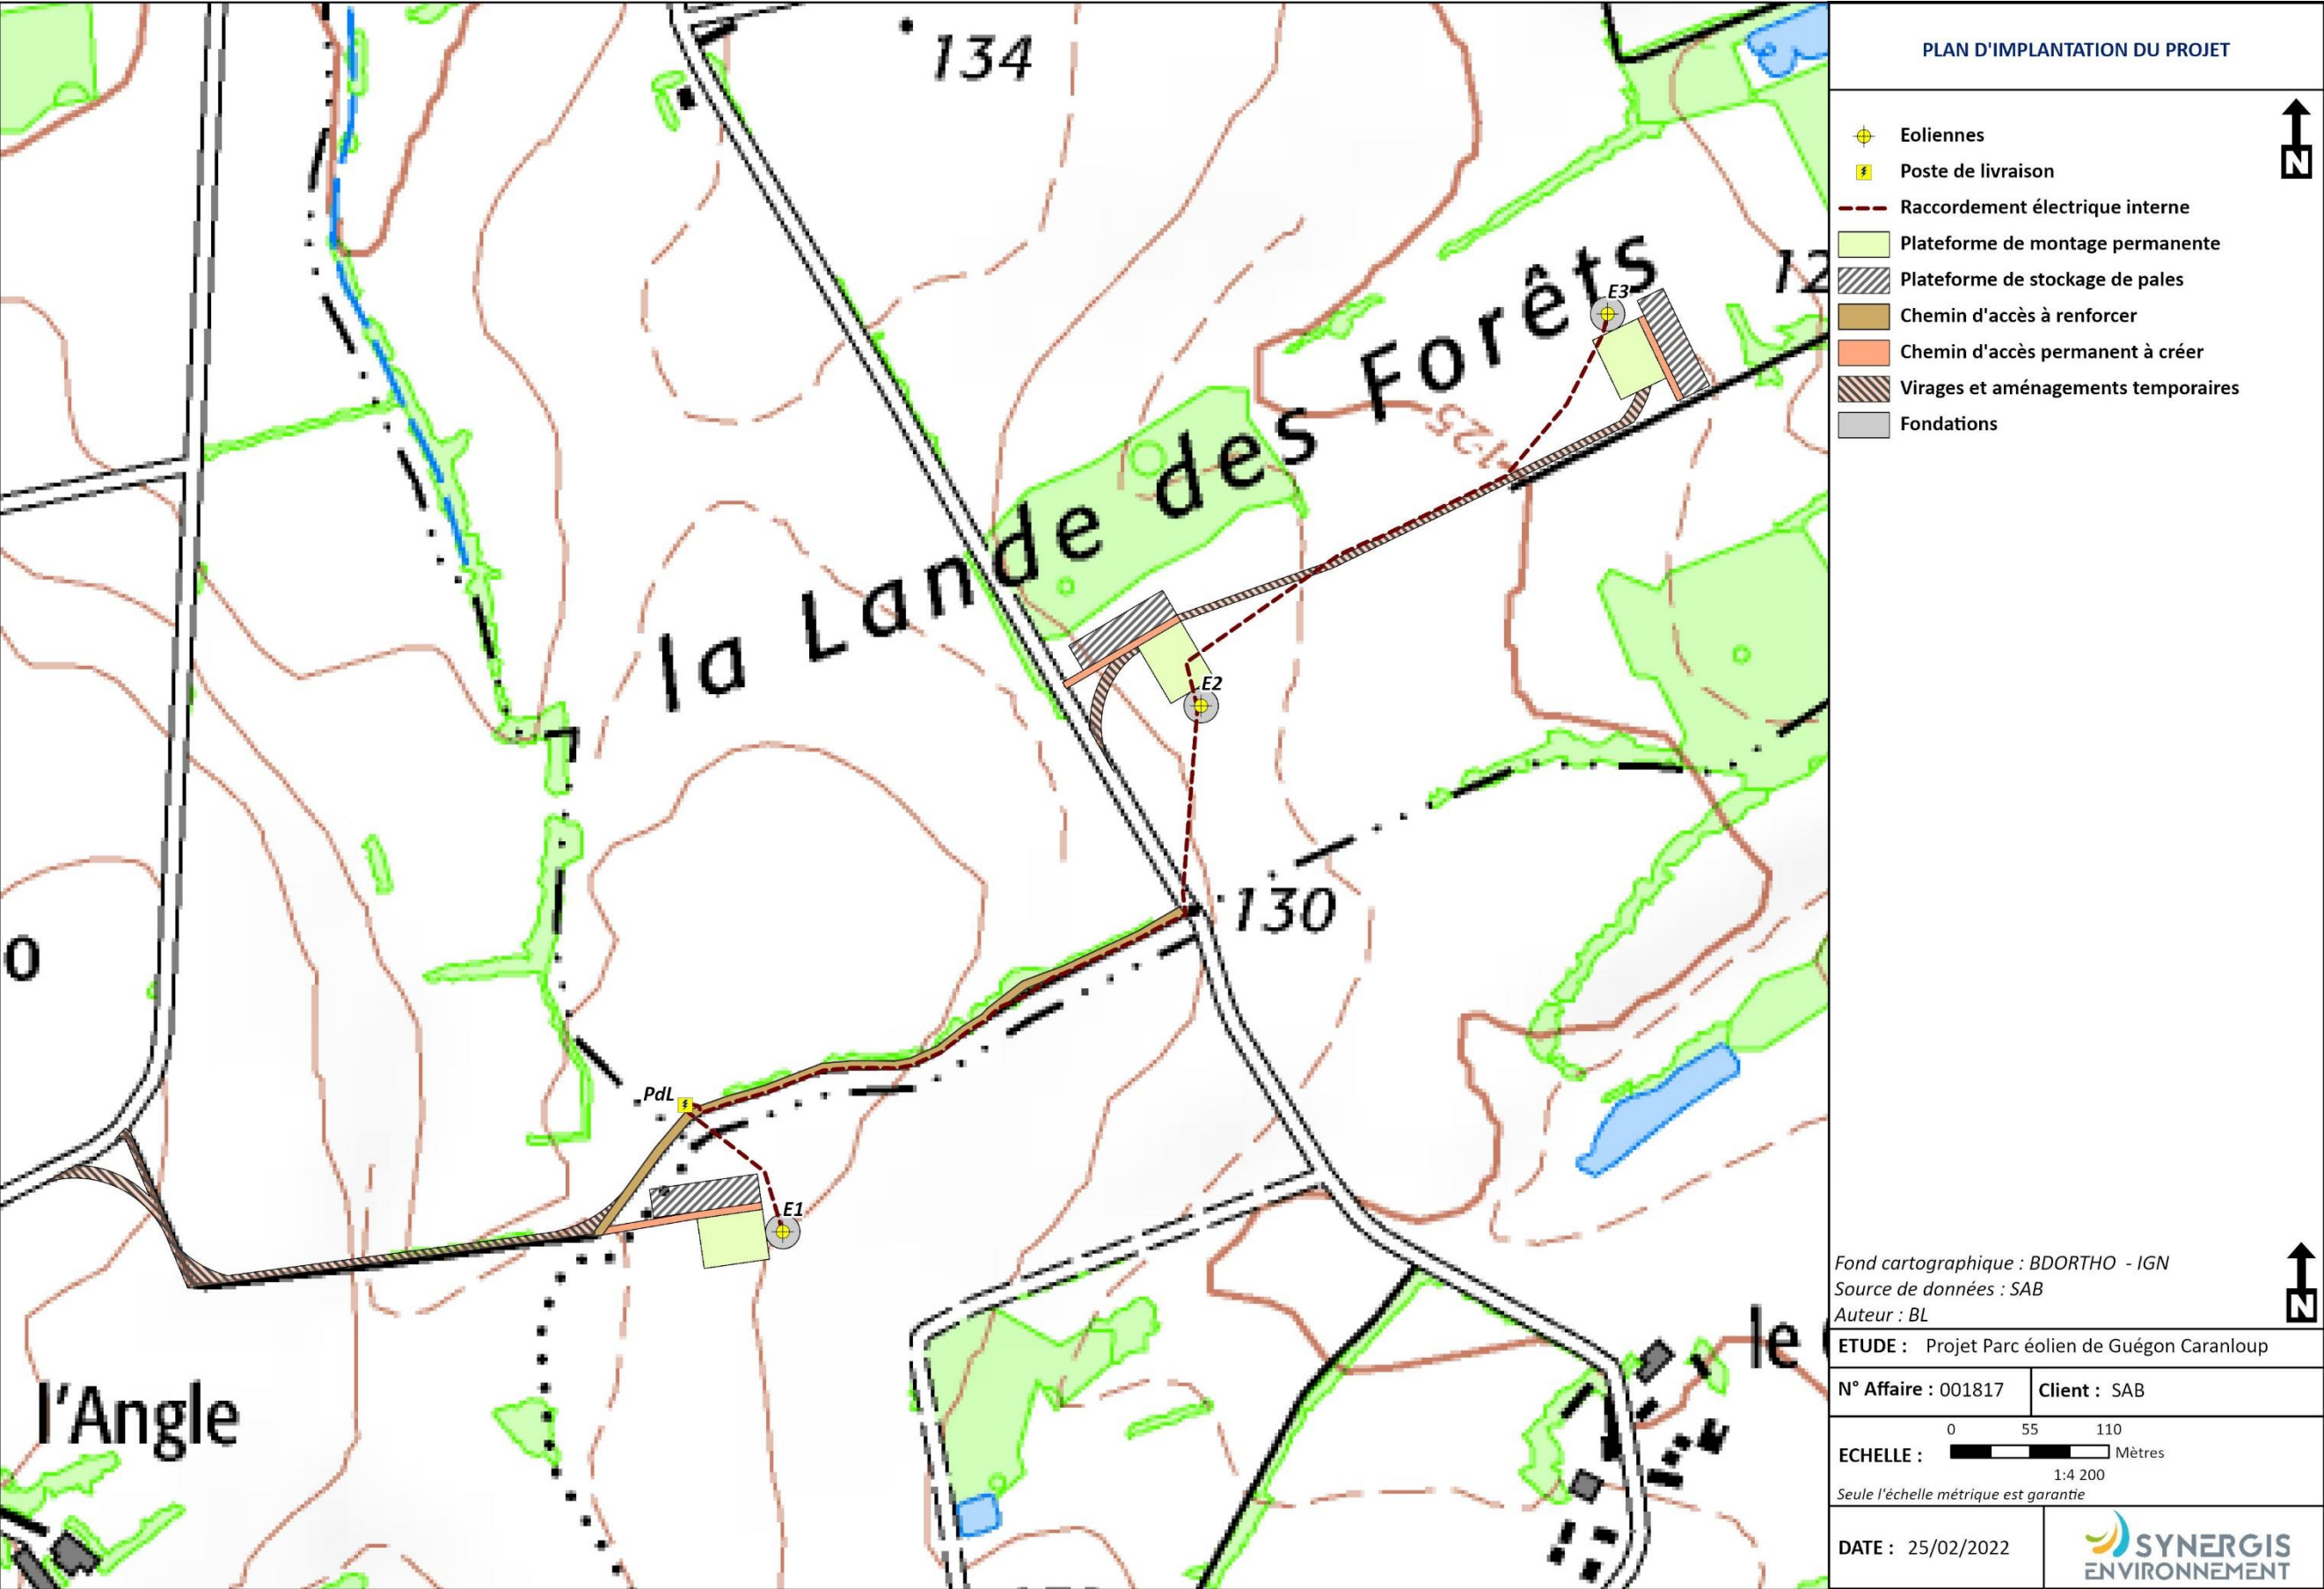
Plan d'implantation du projet de Parc éolien Guégon Caranloup - Fond topographique
